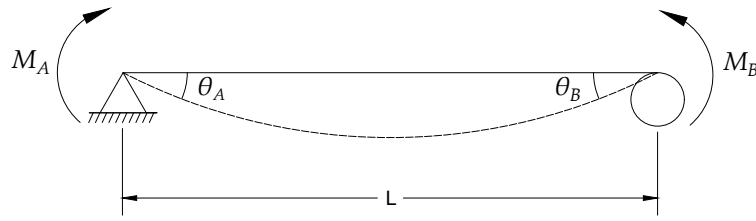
Momentos aplicados a un elemento tipo viga
